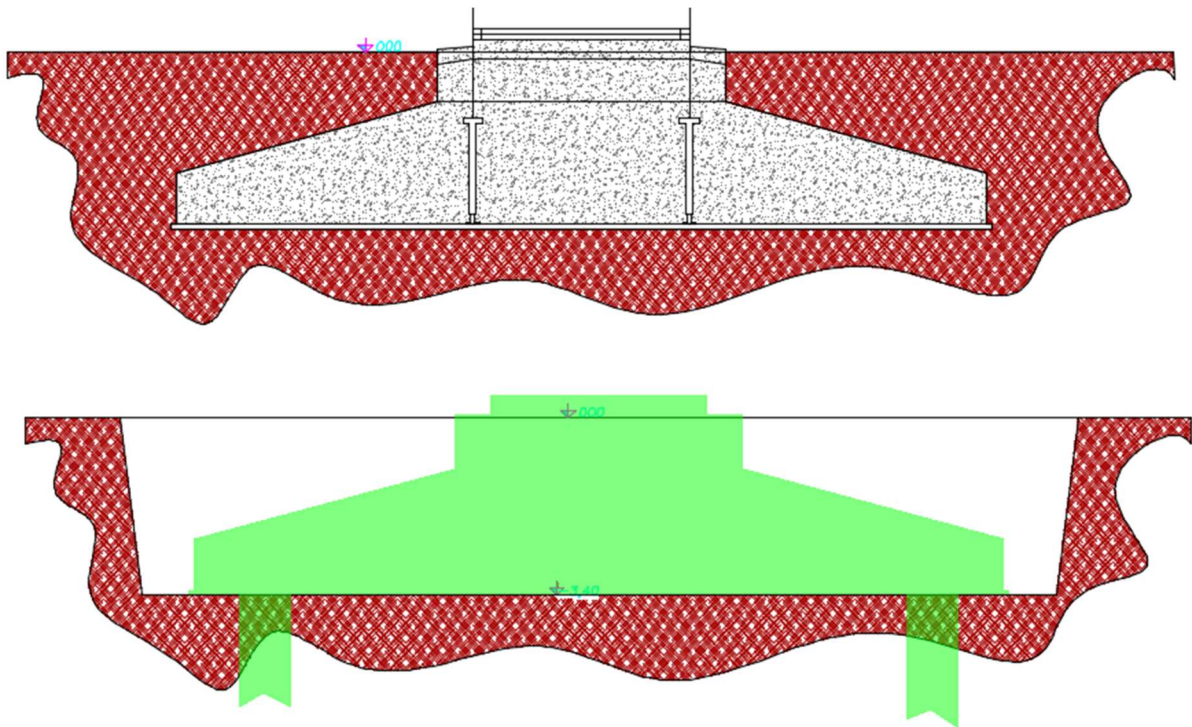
Schema tipico di alloggiamento della nuova fondazione (colore verde) su fondazione esistente e parzialmente demolita (colore grigio).
